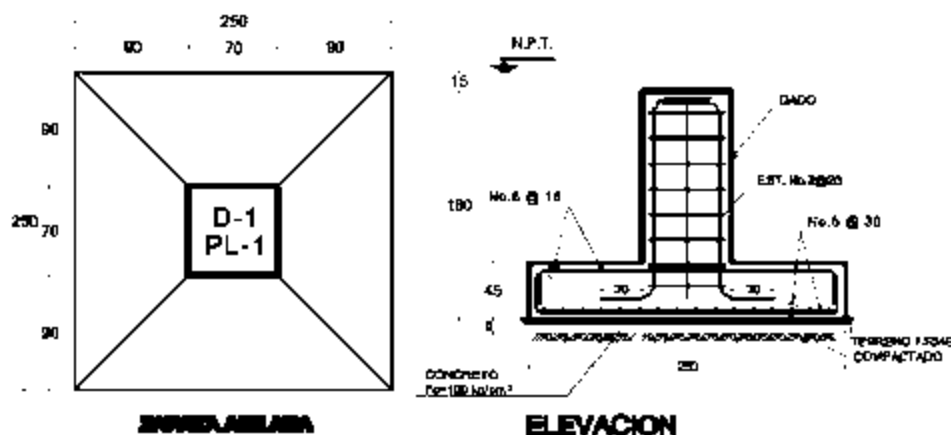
Detalle constructivo de zapata aislada. Elaboración propia AHMZ
